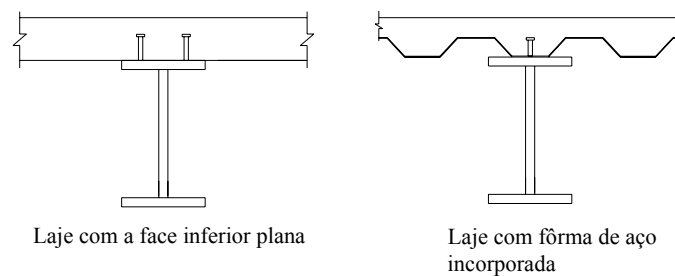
Tipos usuais de vigas mistas Aço-Concreto.
